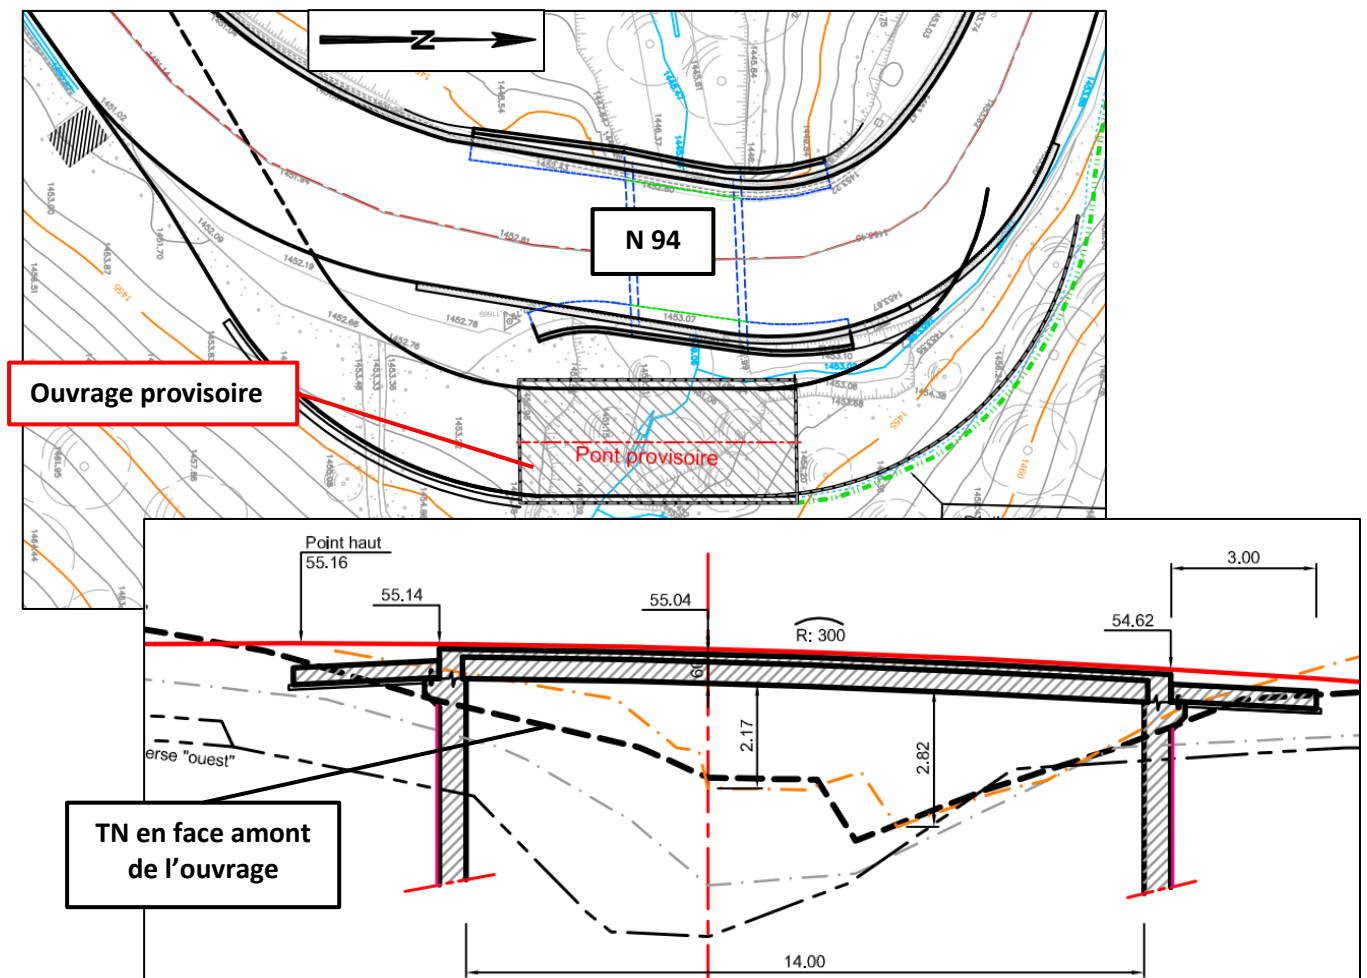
Vues en plan et coupe de l'ouvrage provisoire envisagé
